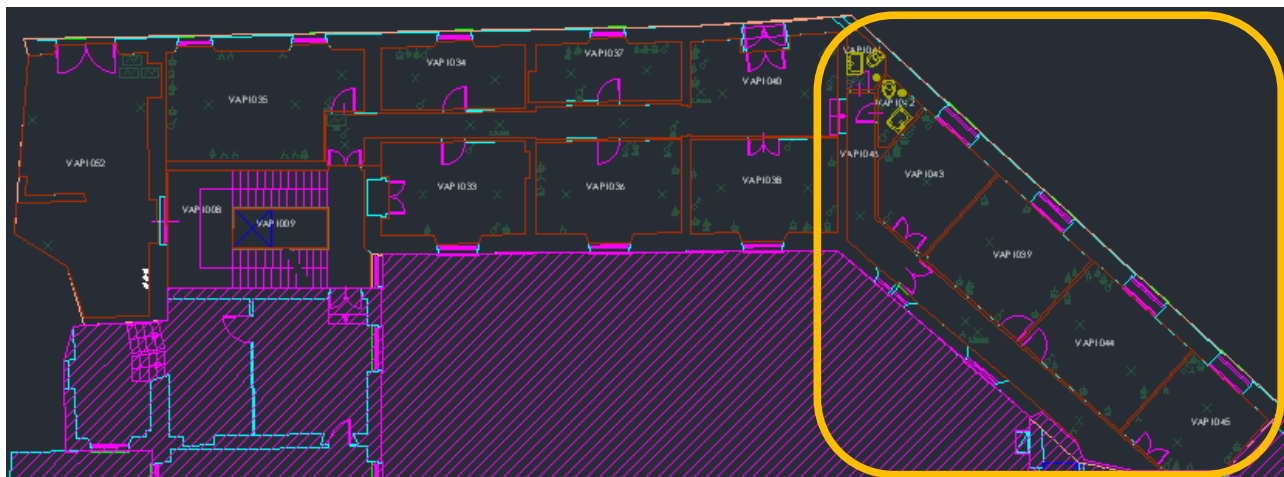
Locali di via Grenchen sede degli interventi del progetto
